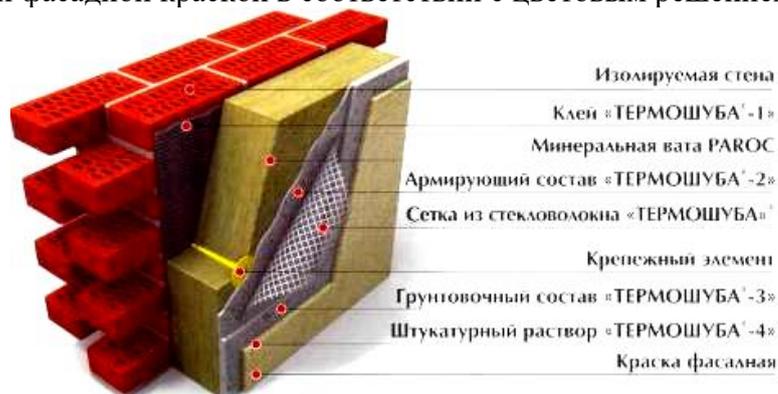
Система утепления фасадов «ТЕРМОШУБА»
